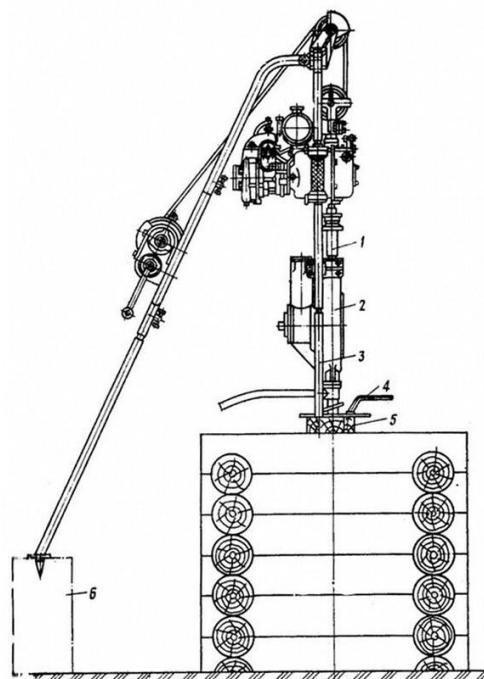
Схема установки МШК-15 на шахтному колодязі: 1 – патрон для відкачування; 2 – насосна колонка; 3 – подовжувач; 4 – підкладна рамка; 5 – поперечина; 6 – додаткова підкладка
